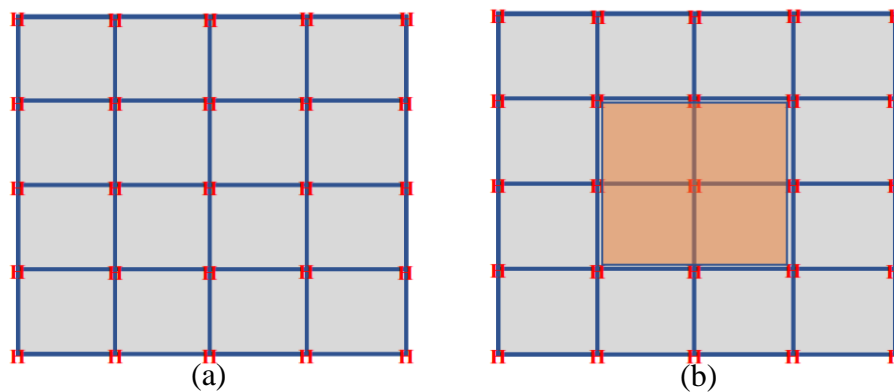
Vista en planta (a) Nivel típico. (b) Último nivel
